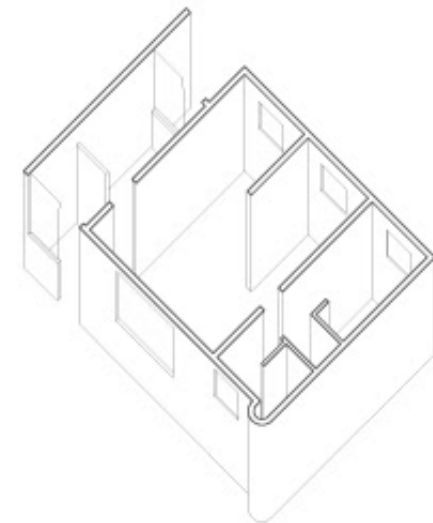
\_Isométrico de la planta de la vivienda San Jacinto en México .D.F. Foto cortesía del museo archivo de la fotografía, México, D.f.
